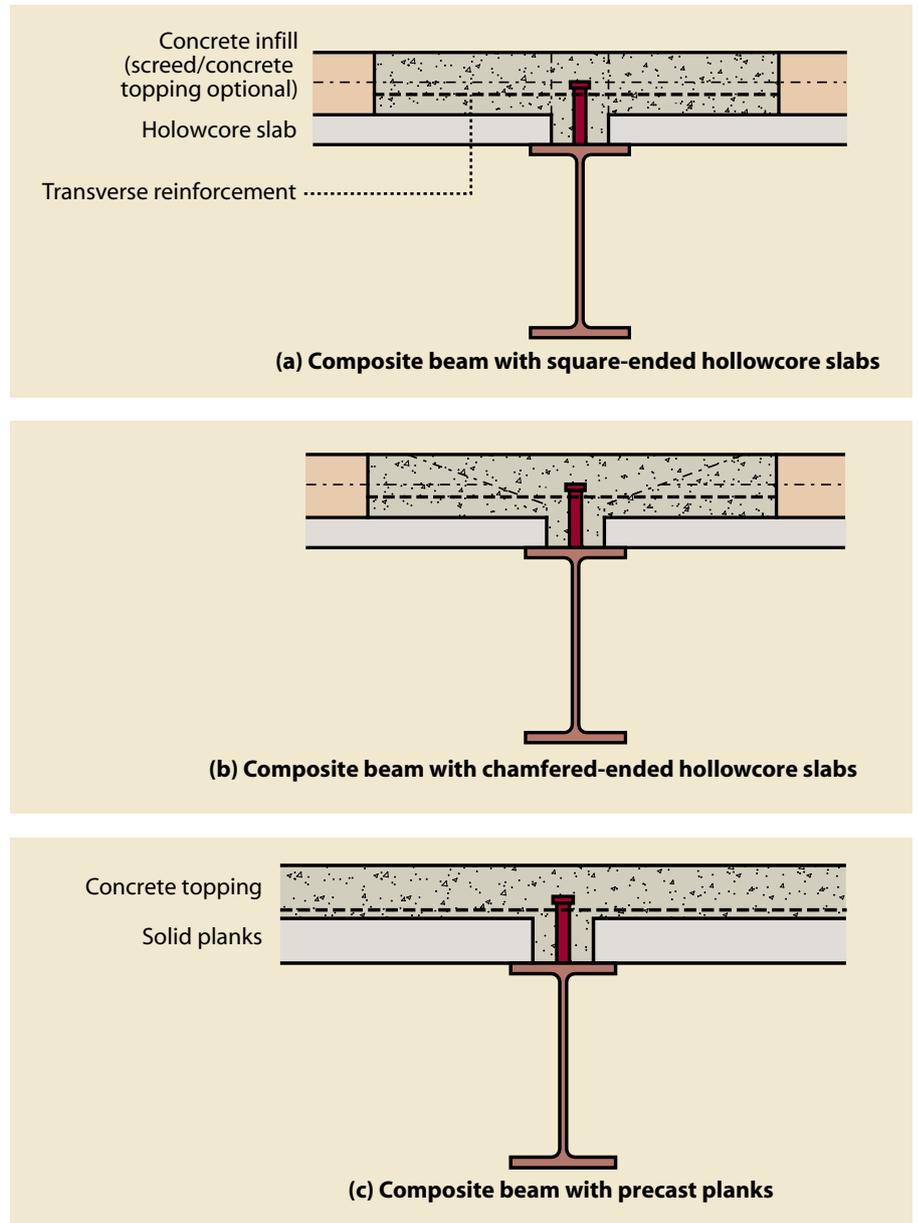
Detalles de vigas mixtas con placas prefabricadas
